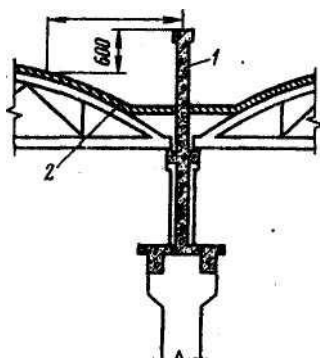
Схема пристрою противопожежної стіни:
